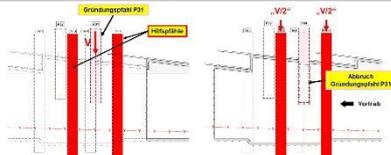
Bruckwiesenwegbrücke - Vortrieb Untertage - Fig. 5 Bruckwiesenwegbrücke – Underground Heading -
